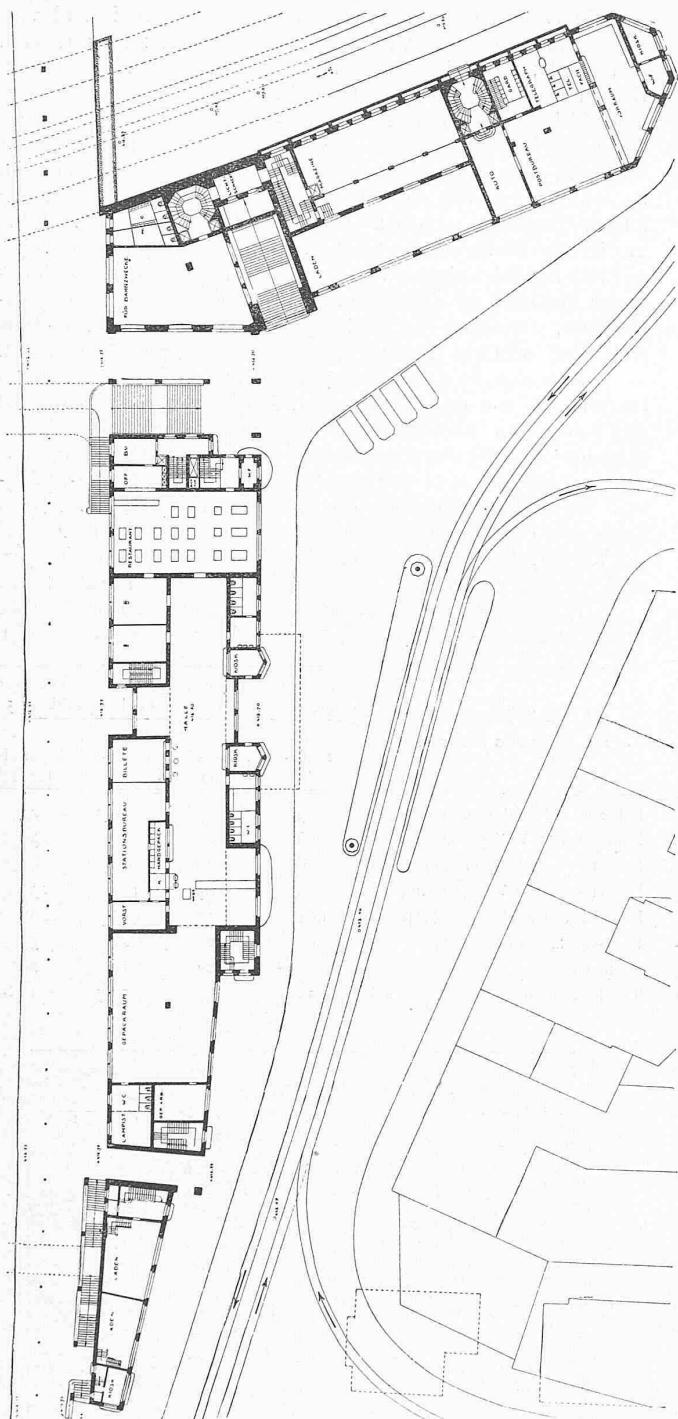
Erdgeschoss-Grundriss mit Bahnhofplatz, Maßstab 1:800.
